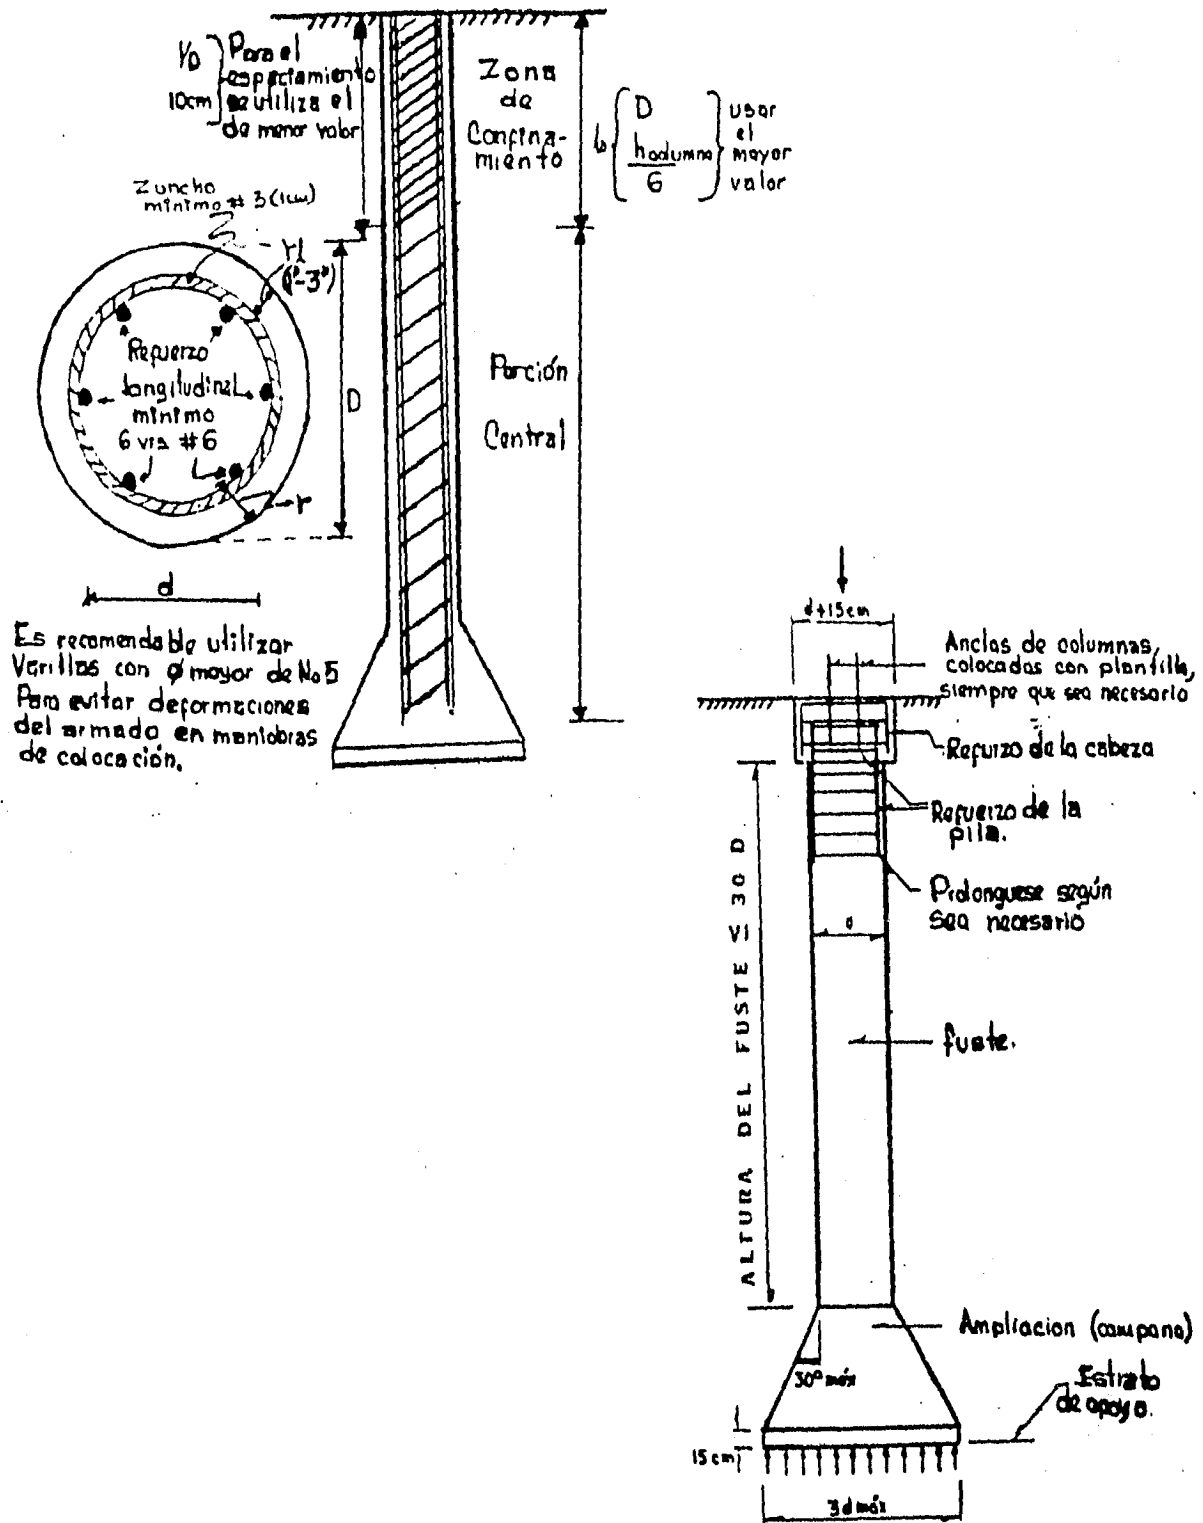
ARMADO DE REFUERZO DE UNA PILA Y SU CONFIGURACIÓN (REF. 7).
